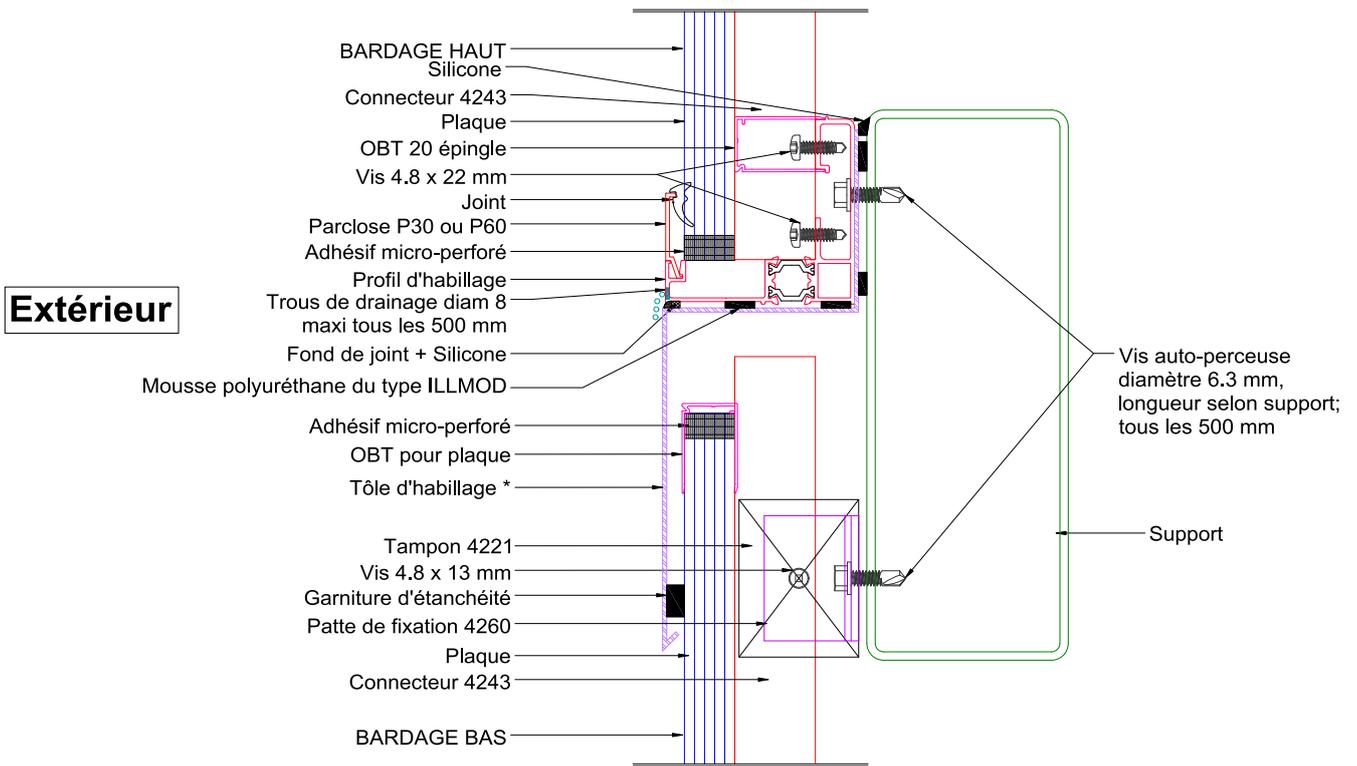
Principe pose avec connecteurs intérieurs - Raccord de hauteur n°3 : façade basse limitée à 16 mètres de haut
